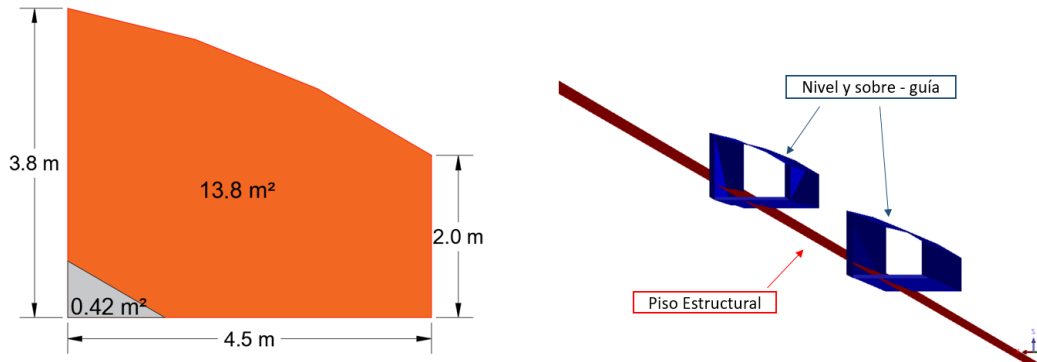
Perfil de la labor delimitada por estructural de piso y techo.
